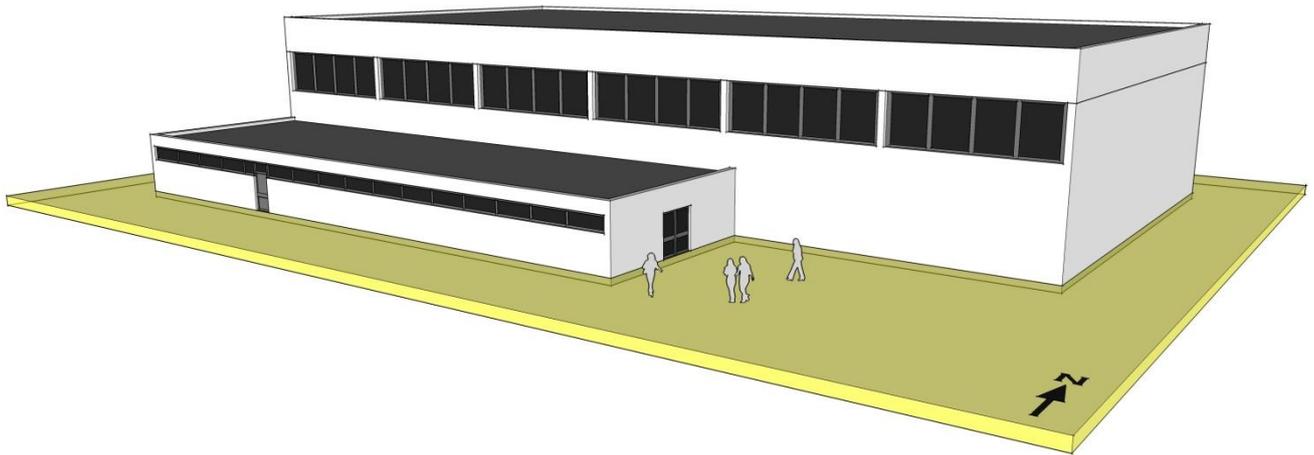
Einfeld-Sporthalle – Darstellung Gebäude – Ansicht Süd-Ost
